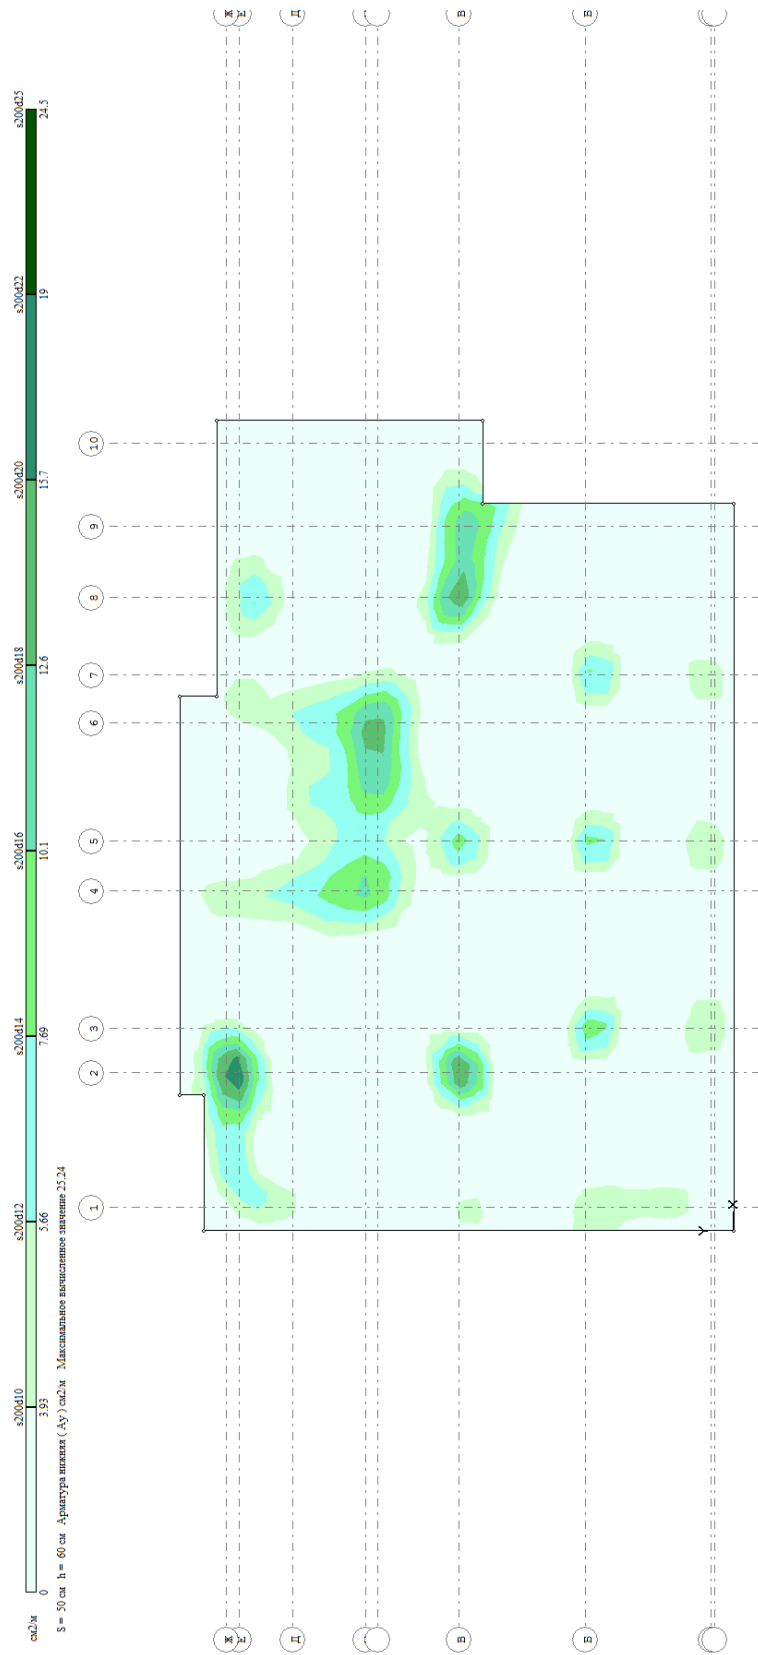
Нижняя арматура по Y - фундаментна плита
